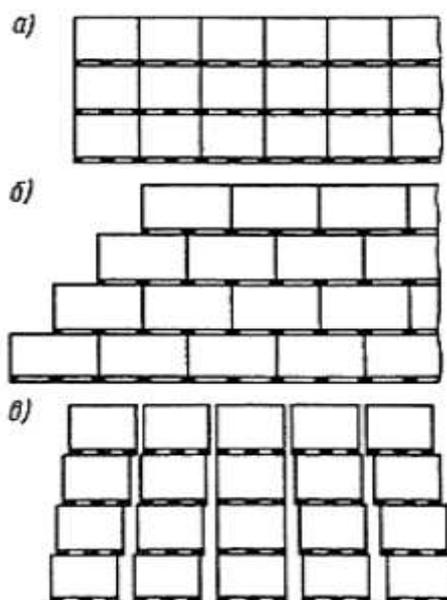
Схемы укладки штабелей: а – прямой кладки; б – с уступами; в – со смещением
